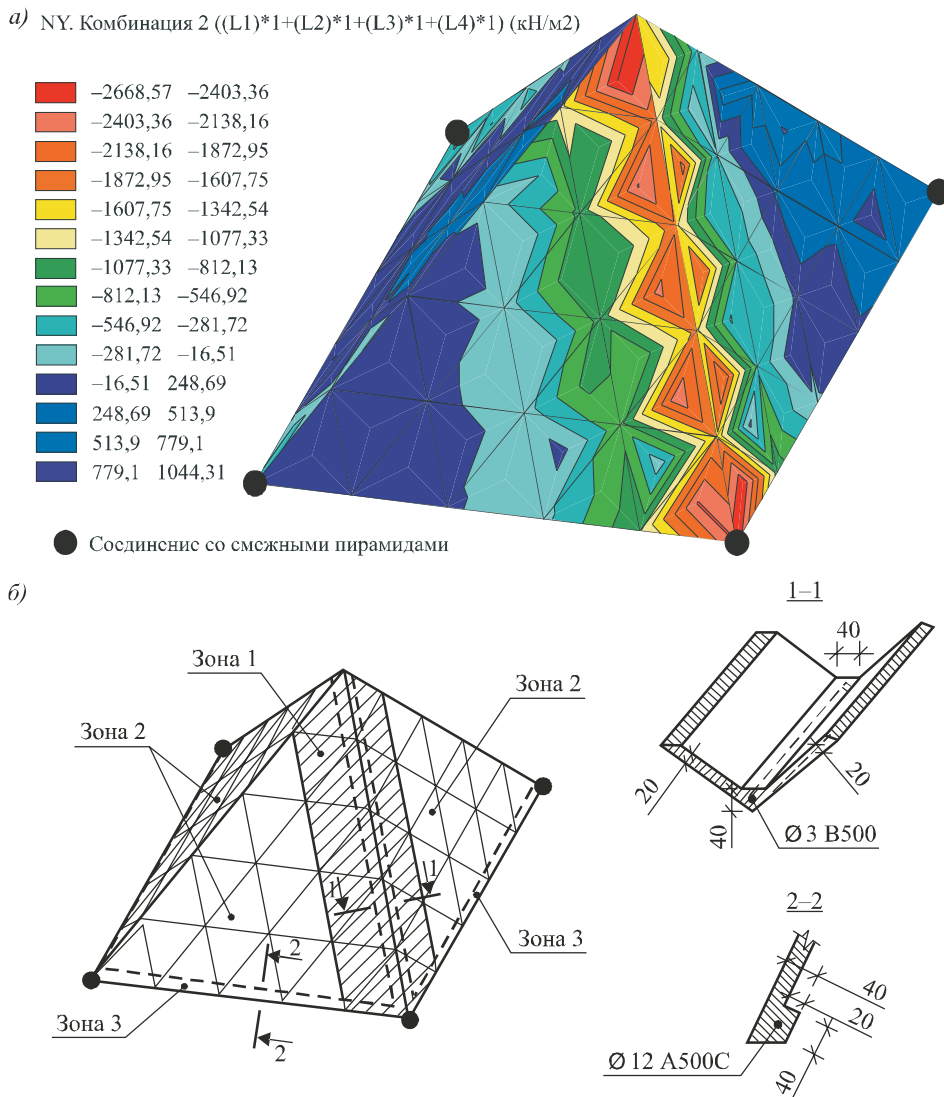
Схемы к расчету пирамидального элемента нижнего пояса П-2 структурного тонкостенного сталефибробетонного покрытия
